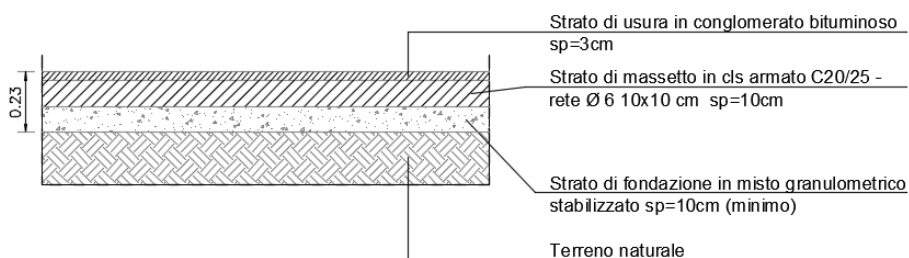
Pacchetto pavimentazione marciapiede e pista ciclopedonale
